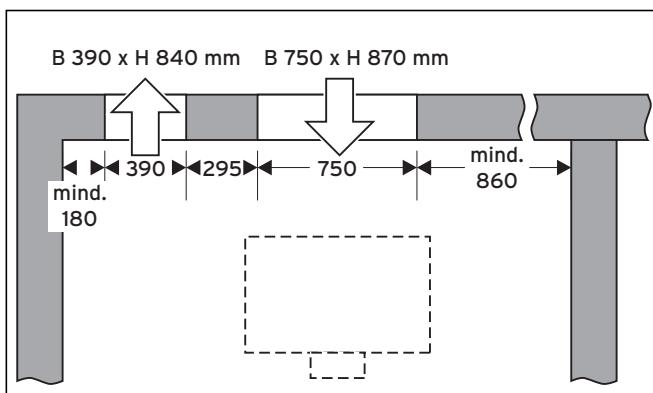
Wandinstallatie, luchttuitgang rechts
